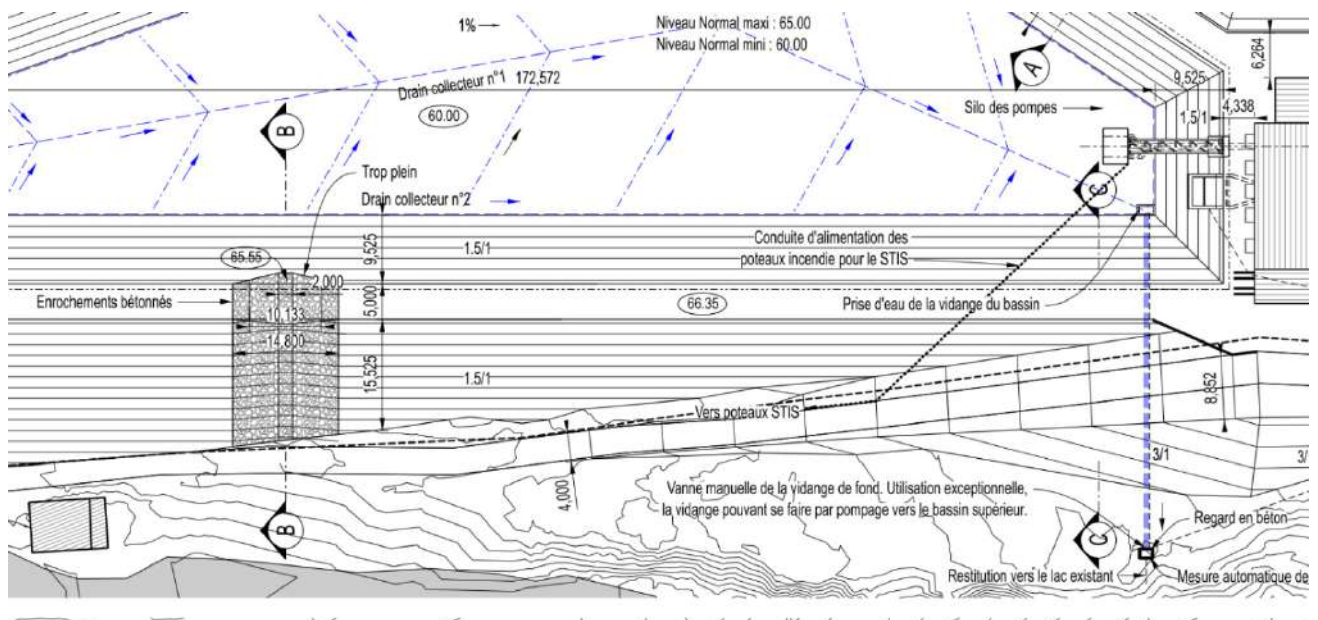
Zoom sur la vue en plan du bassin inférieur (source : ISL Ingénierie)
